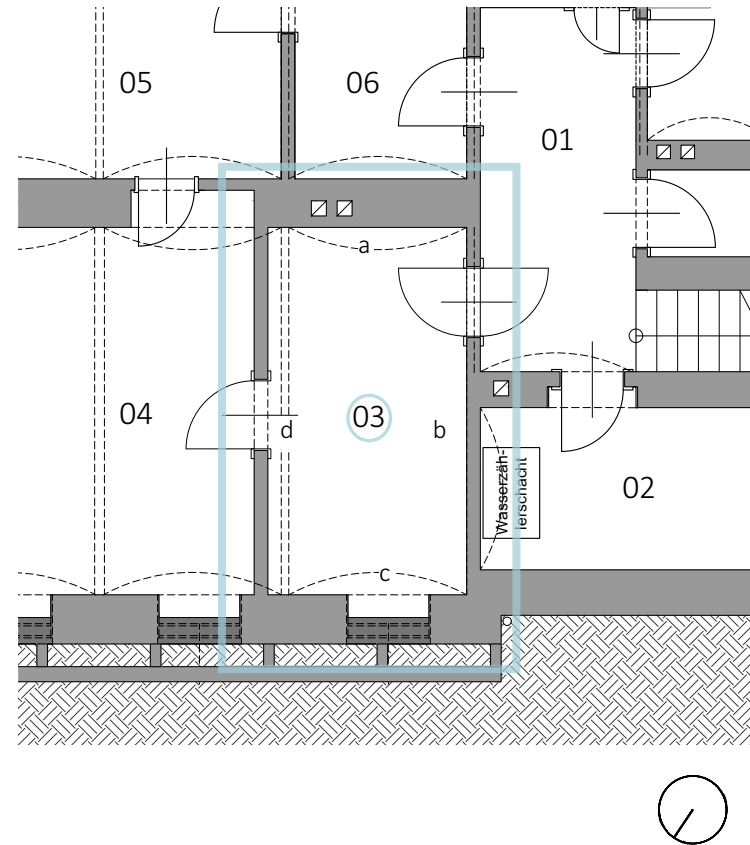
Grundriss UG 03 Kabinett Straßenseite, M=1:100.
